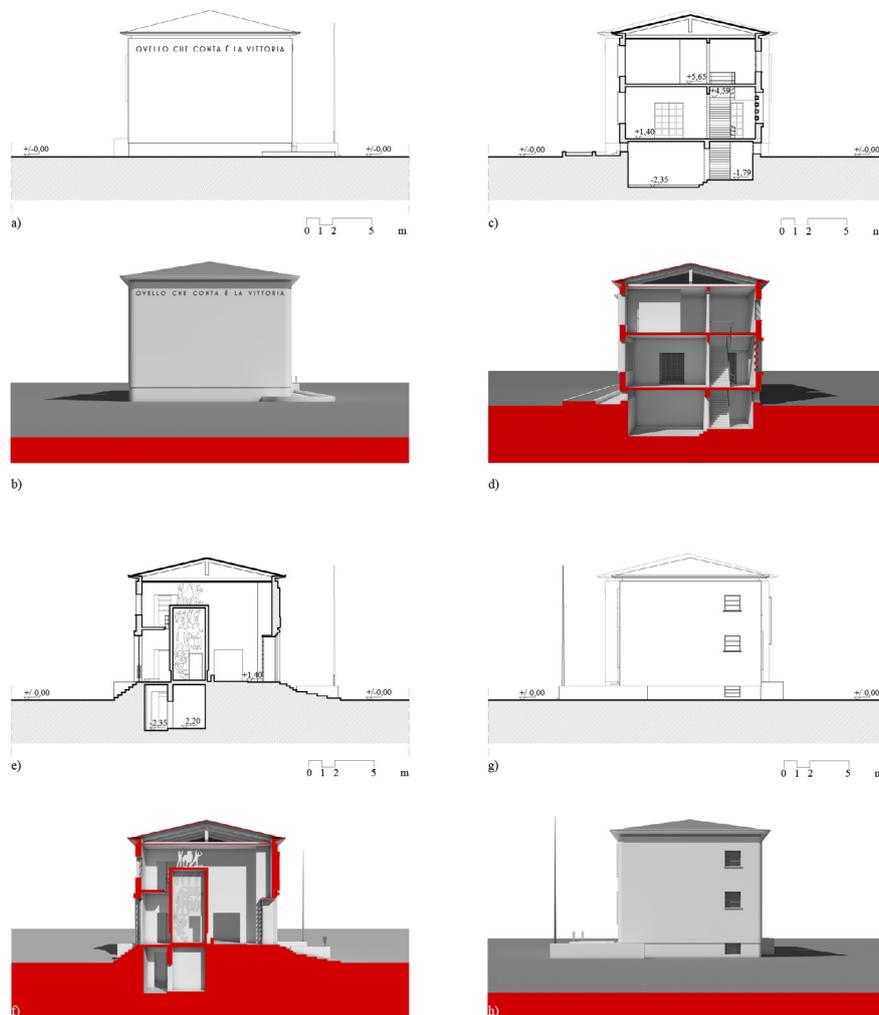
Ridisegno della Casa del Balilla di Luigi Moretti per la città di Bitonto: a) Sezione EE; b) Sezione prospettica EE; c) Sezione FF; d) Sezione prospettica FF; e) Sezione GG; f) Sezione prospettica GG; g) Sezione HH; h) Sezione prospettica HH.
